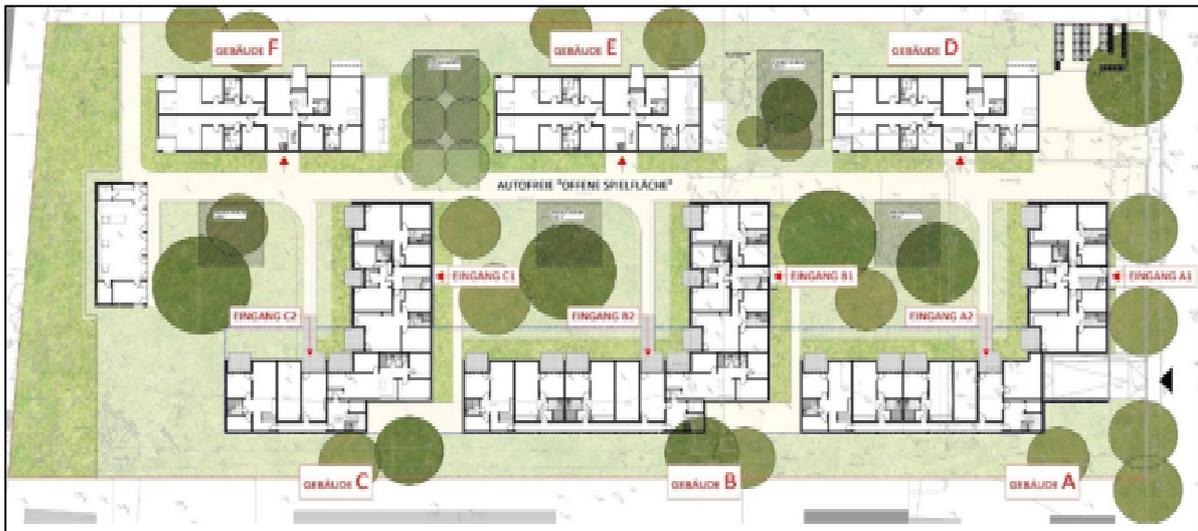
Bereich „MI 2“, Übersichtsplan Gebäude, Lageplan, Stand: 26.03.2025; (Quelle: Stadt Mainz und "Wohnbau Mainz GmbH)
